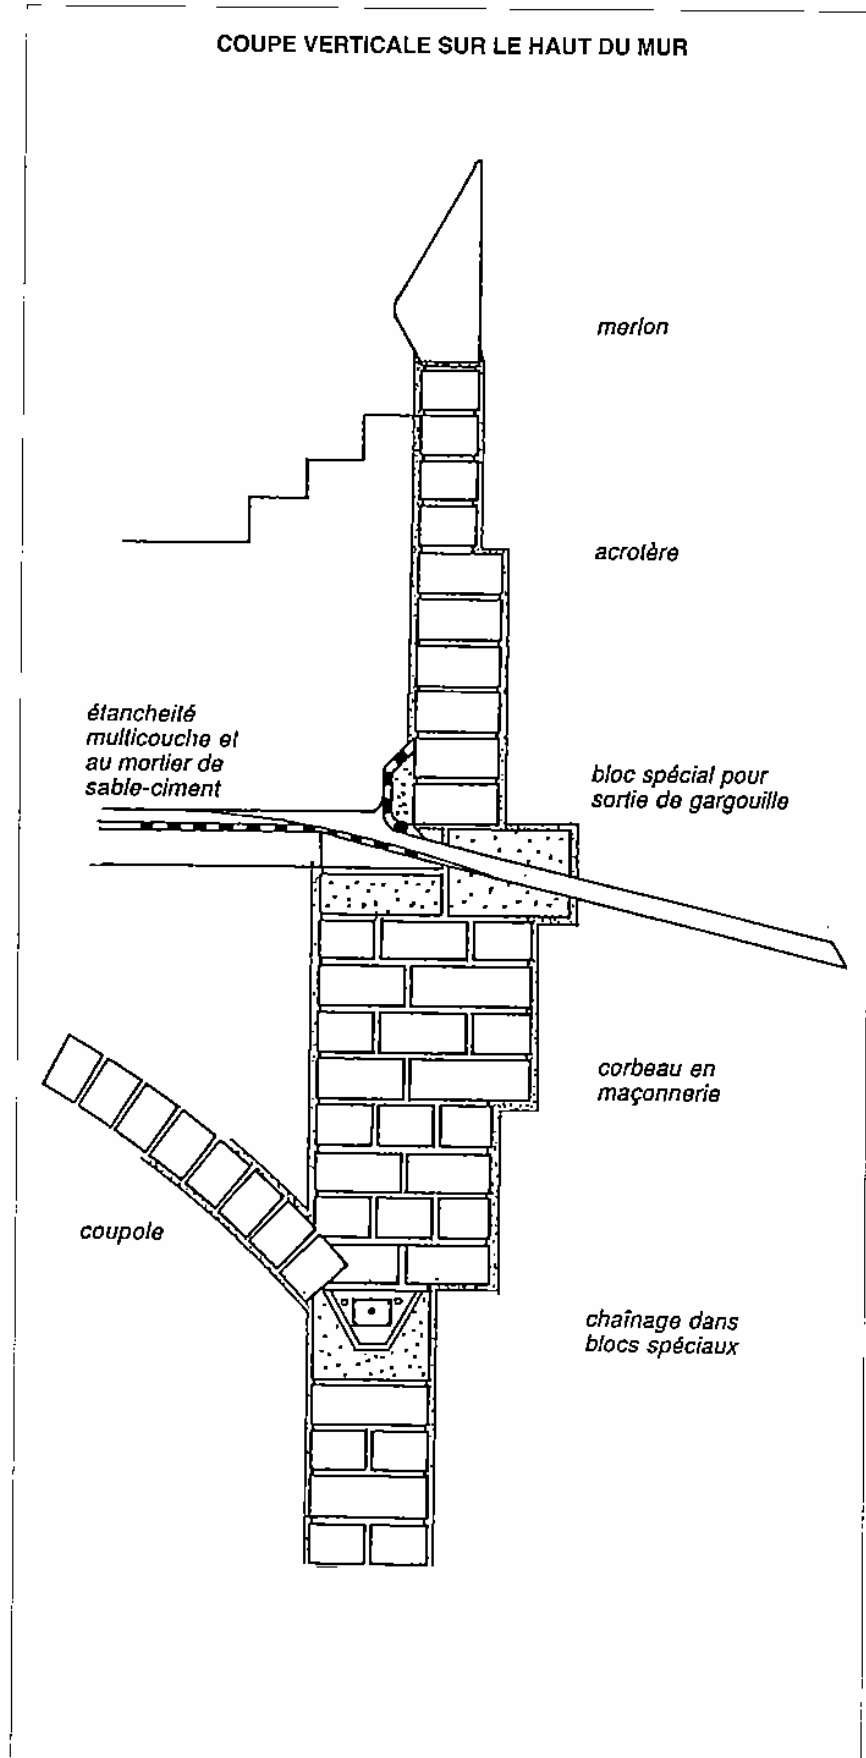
Coupe verticale sur le mur extérieur du chaînage au merlon.
